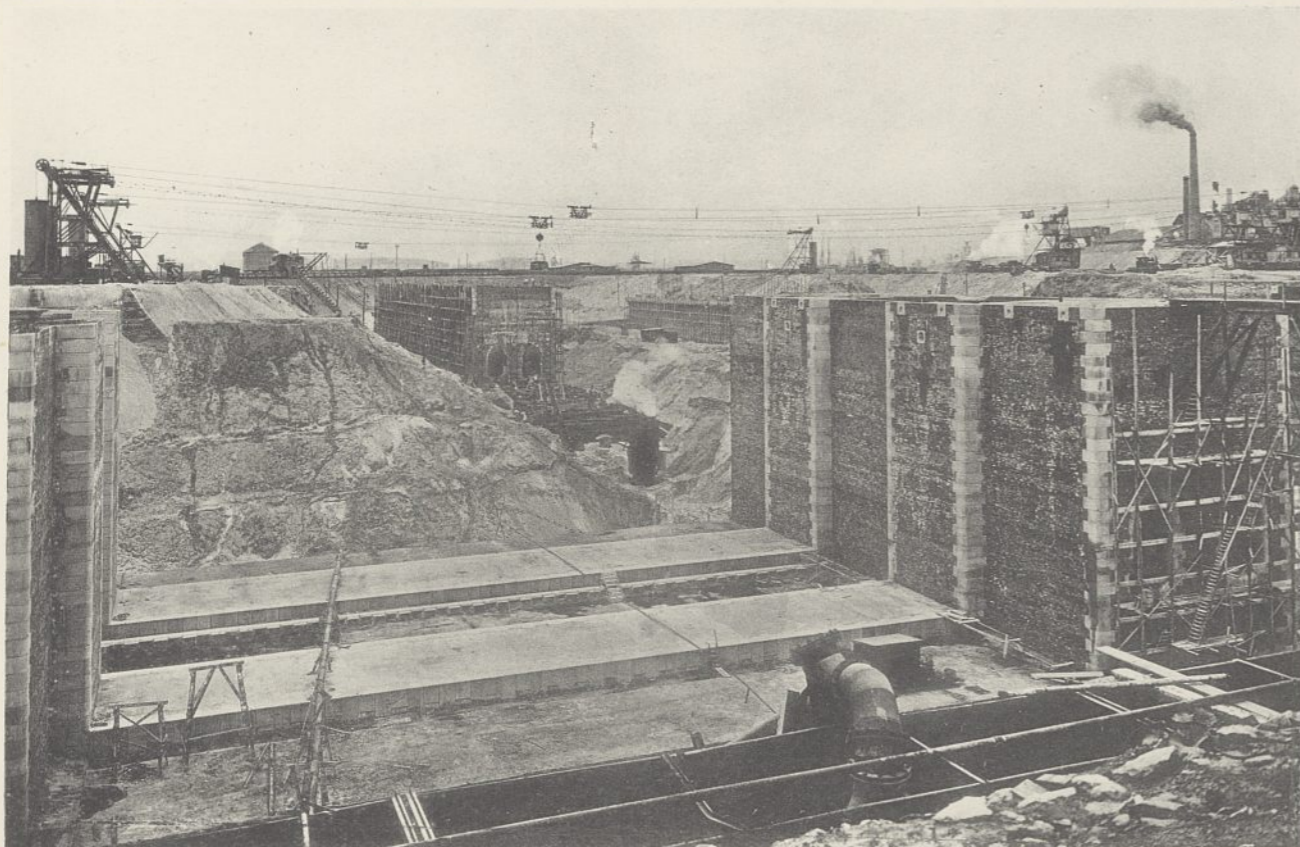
Betonierungsarbeiten im Bauabschnitt II.
